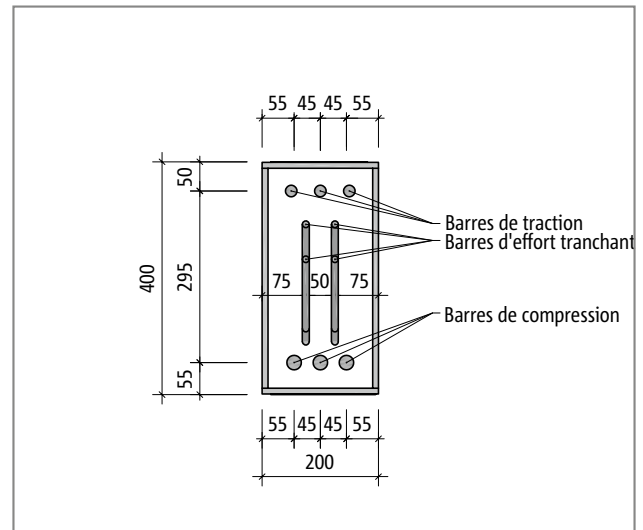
Schöck Isokorb® T Type B-M2-V2 en hauteur H400 : Vue du produit
